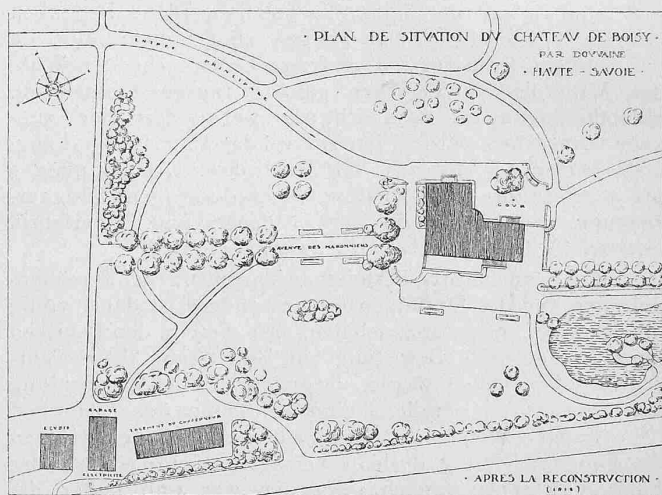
Jetziger Zustand. — Lageplan 1:2000.
